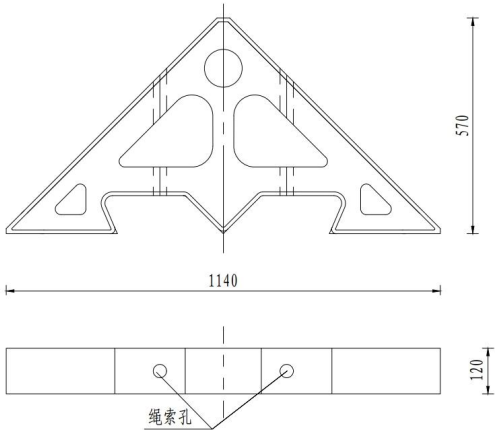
三角形生态砌块 A 平面及侧面图
